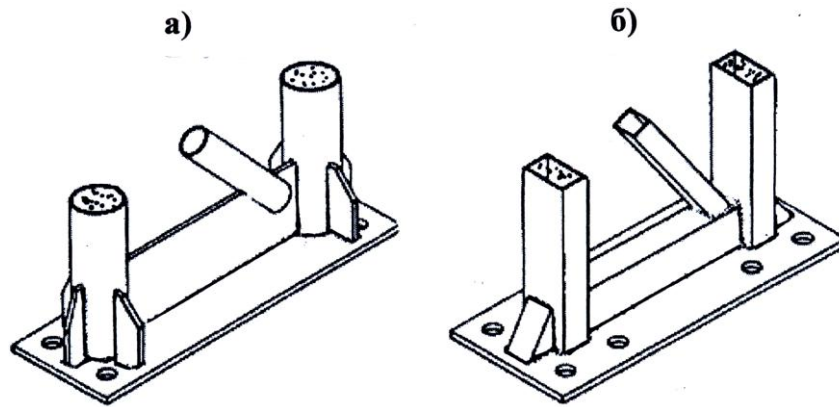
Базы колонн с трубчатыми (а) и коробчатыми (б) ветвями
